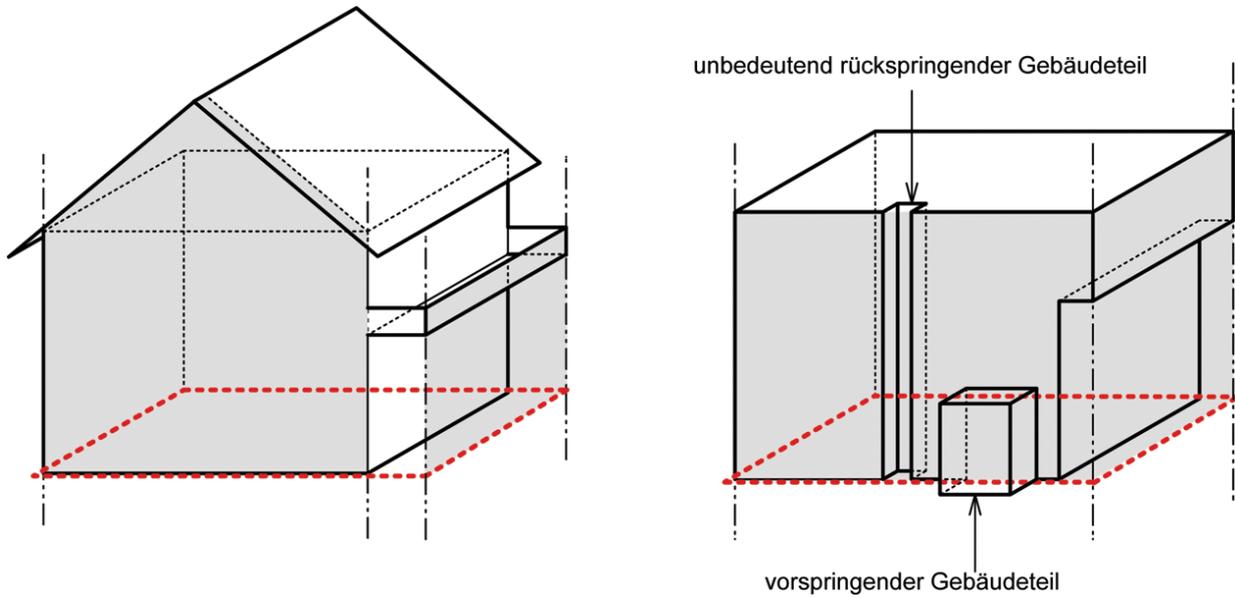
2.3 Gebäude, Anbauten und Kleinbauten
